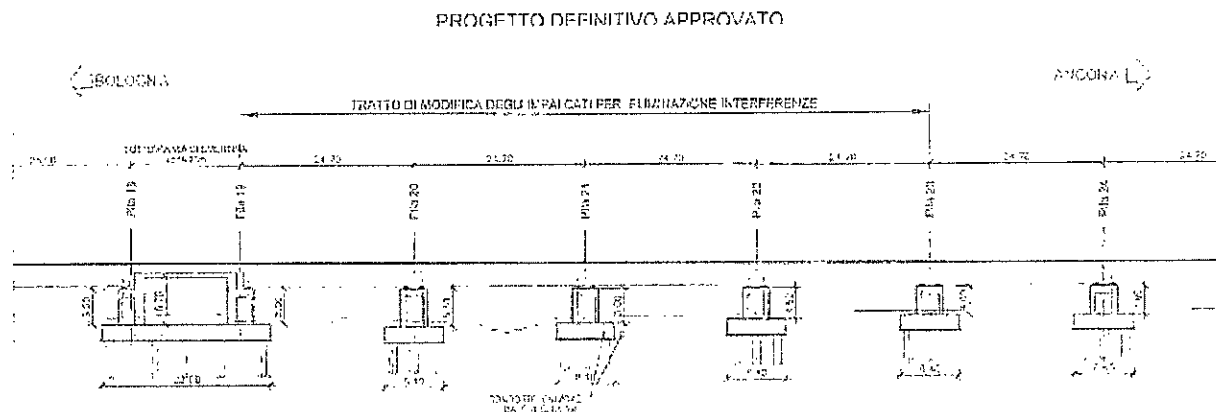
Stralcio di profili longitudinali progetto definitivo approvato
